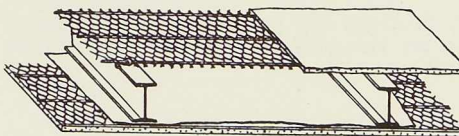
Plancher avec dalles coulées sur treillis métallique.
